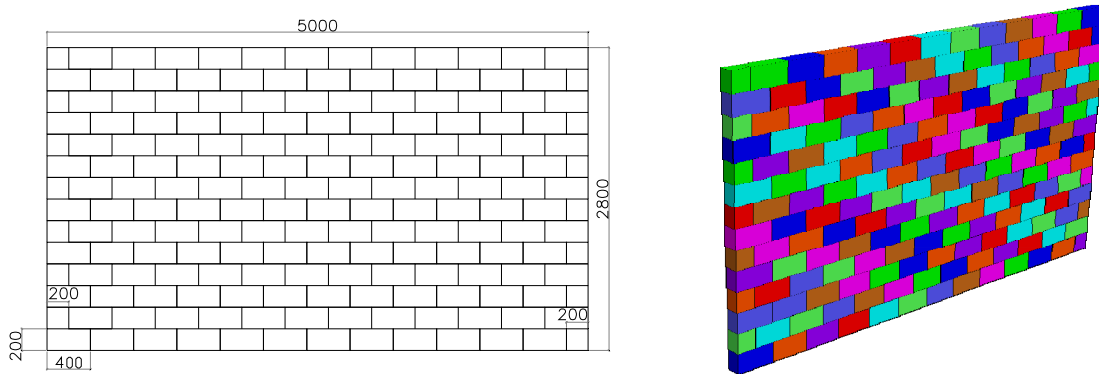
Géométrie et dimensions des murs: WII; WP1; WF.
